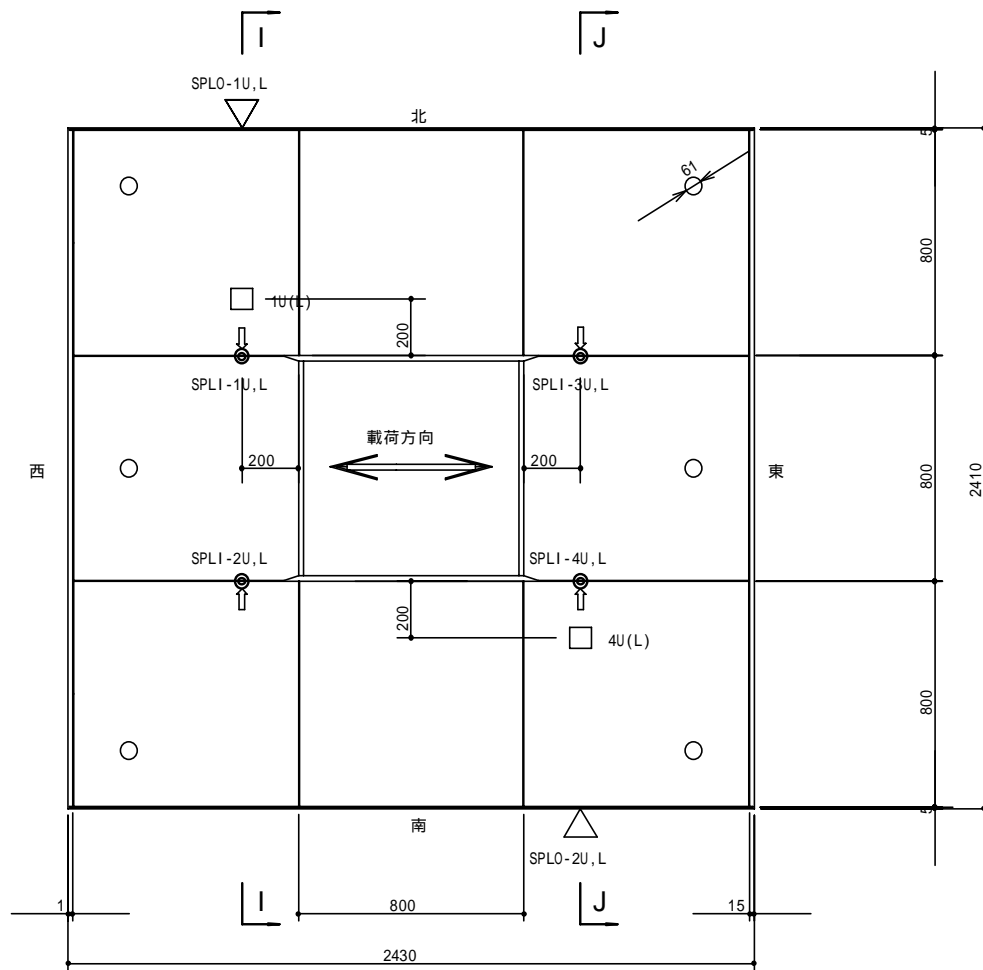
下面鋼板ひずみ計配置図 (F-2 試験体)
